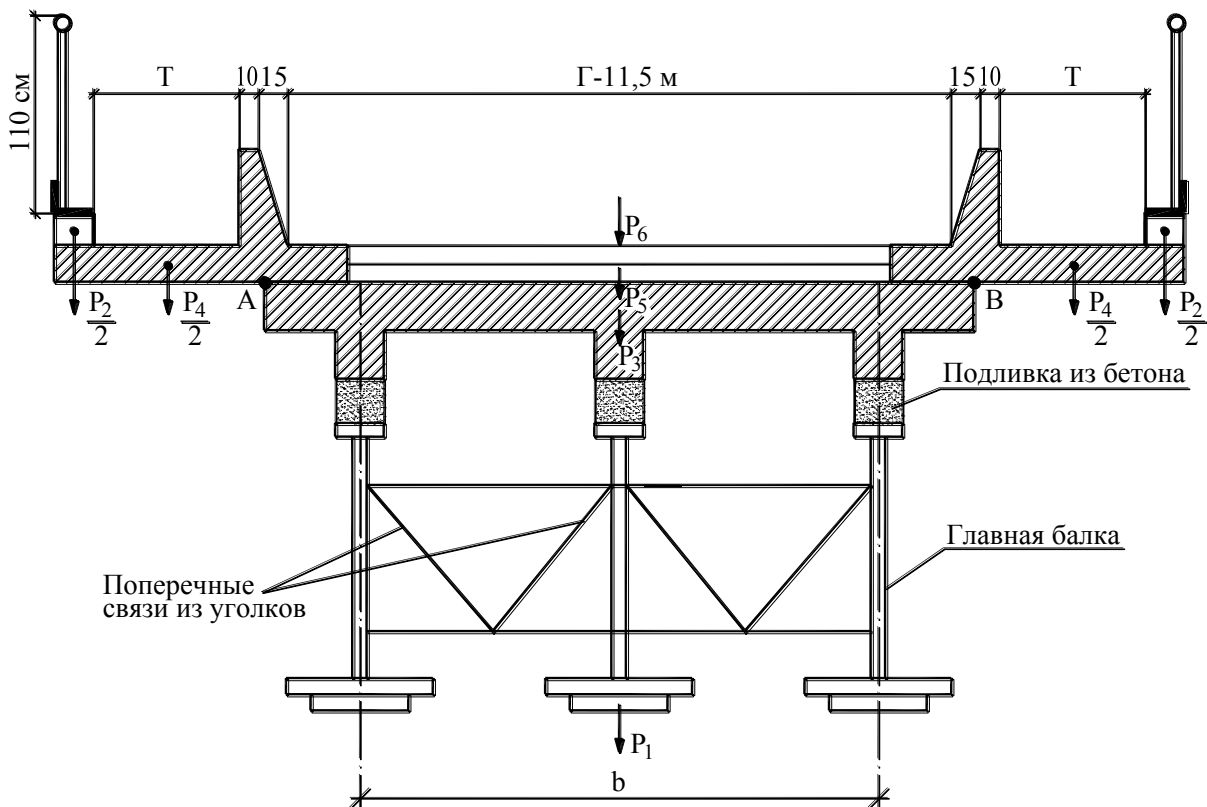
Схематический поперечный разрез сталежелезобетонного пролетного строения для габарита Г-11,5 м
